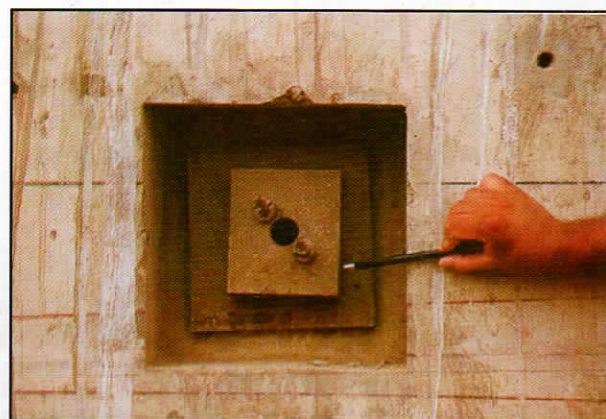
Detalle del anclaje de los muros pantalla de la rampa en espiral.
